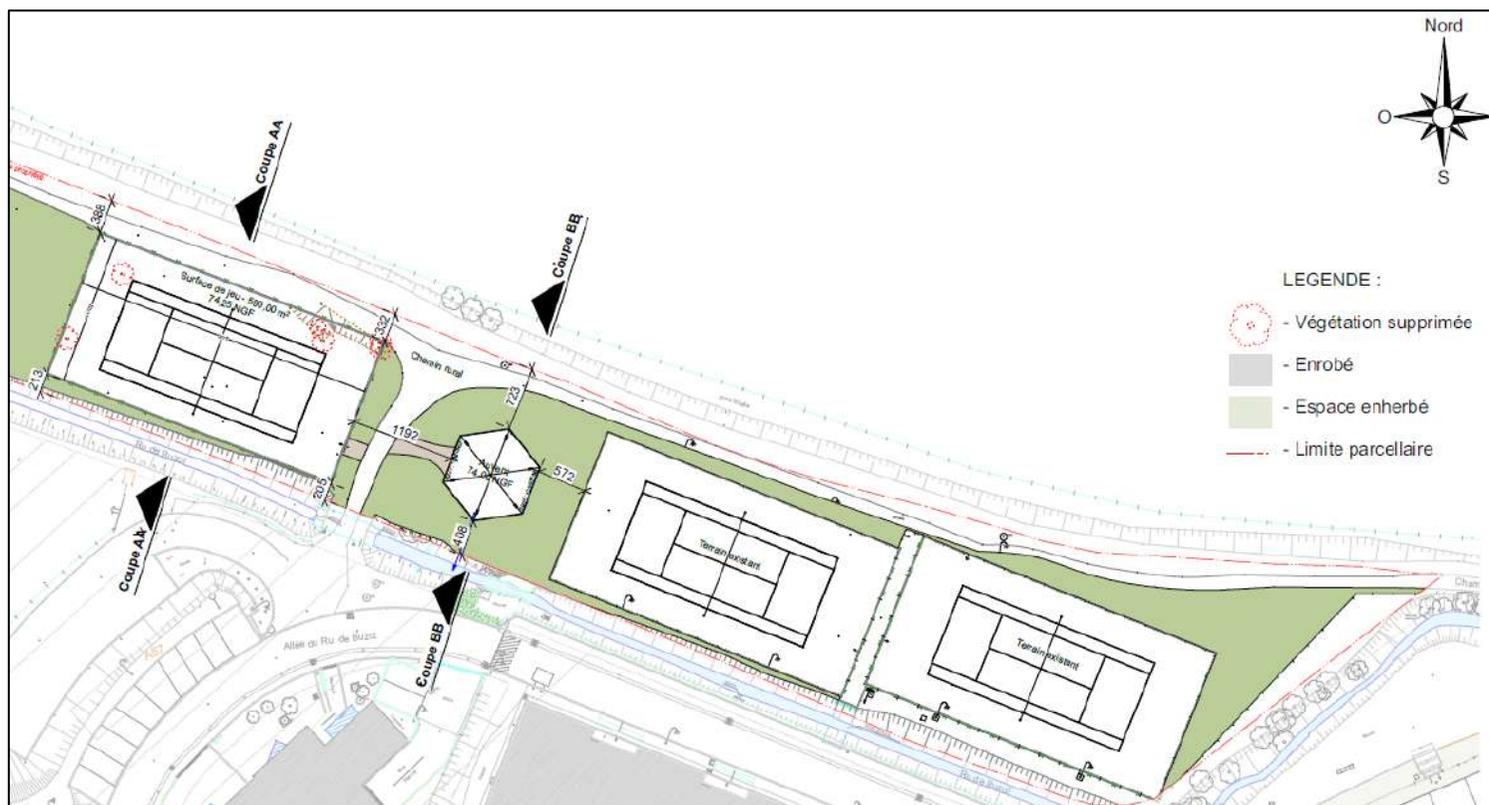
Plan masse du projet - zone B, SAS Architecture 3J
